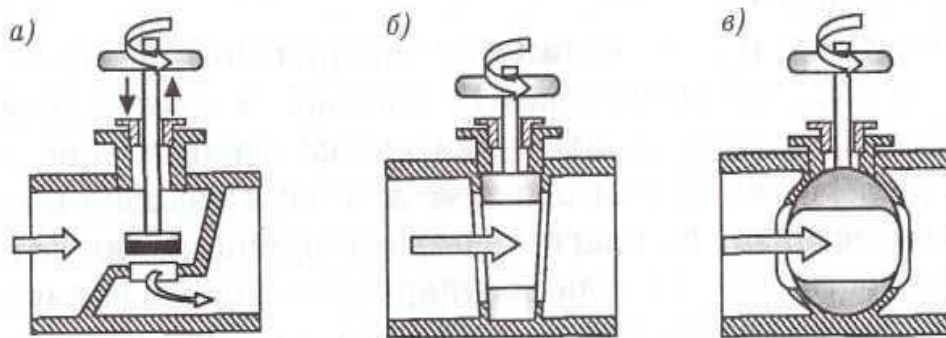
Принцип действия водопроводной арматуры: а – вентильной; б – пробковой; в – шаровой
